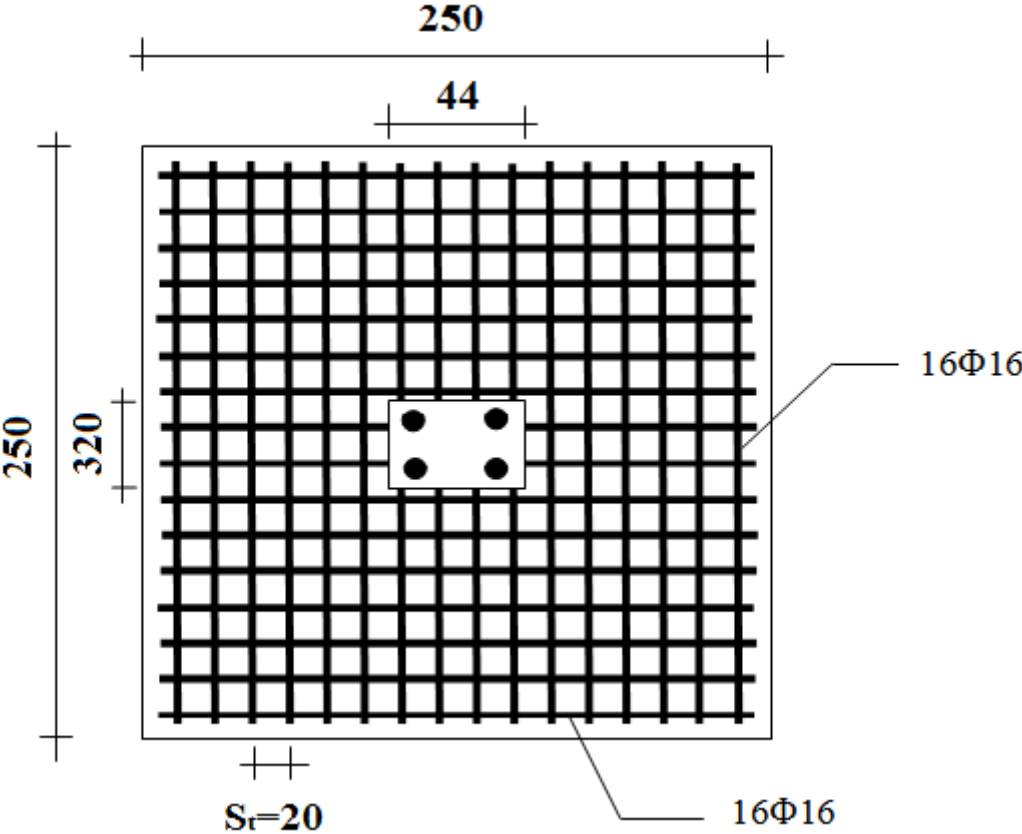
Schéma de ferrailage de semelle isolée .
